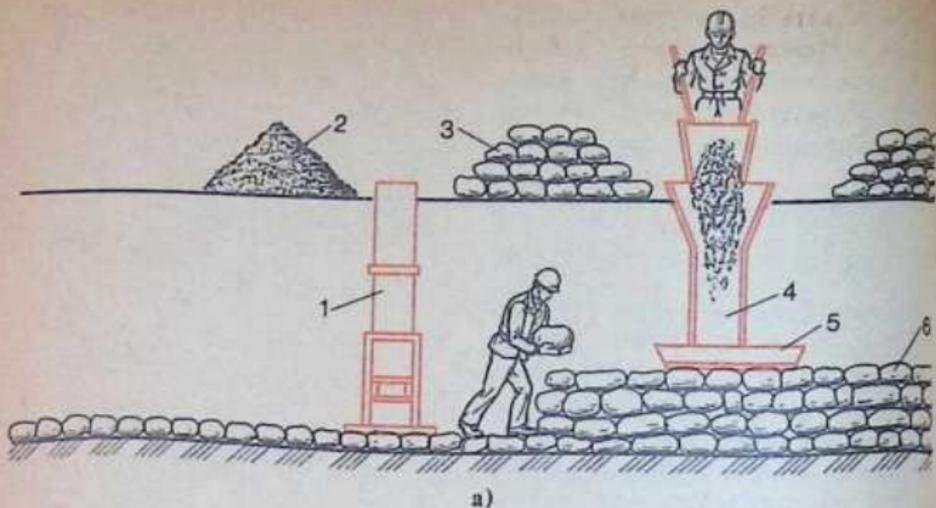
Организация рабочего места при бутовой кладке фундаментов в траншеях (котлованах) глубиной более 1,25 м:
